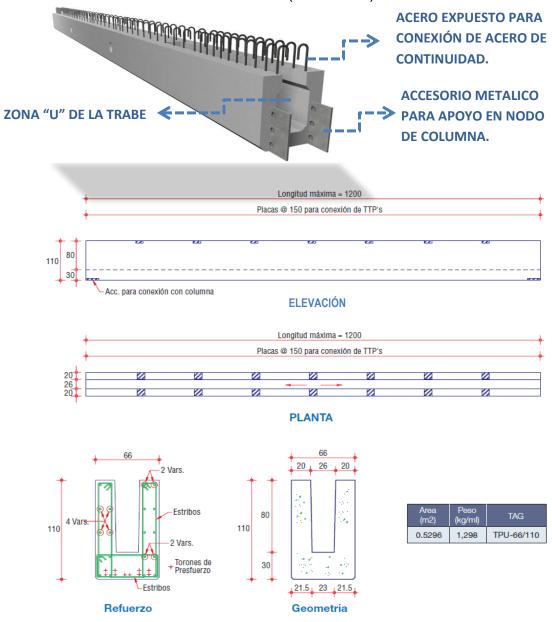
Isométrico y esquema de armado para trabe portante de losa alveolar tipo TPU.
